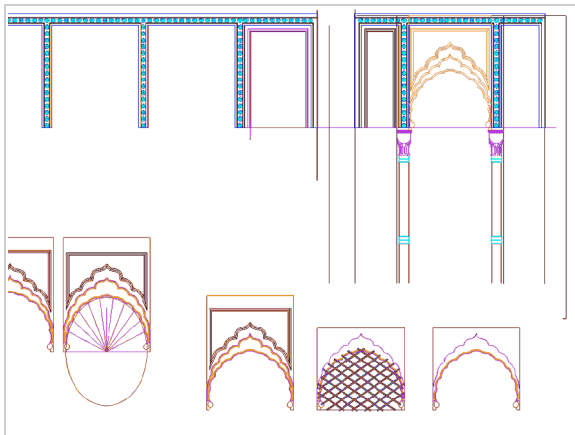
Montage der Bogenfelder und der Wandauflagen des Obergeschoßes im Grundriss.
